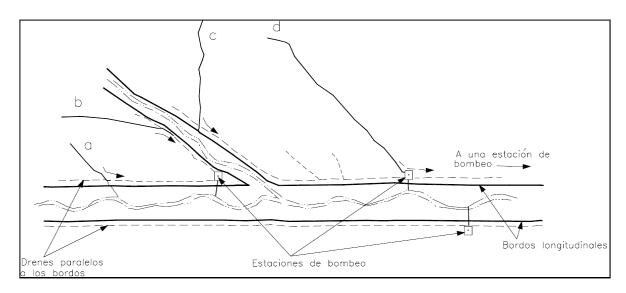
Drenaje en de planicies con bordos longitudinales. (Maza, 1996)
